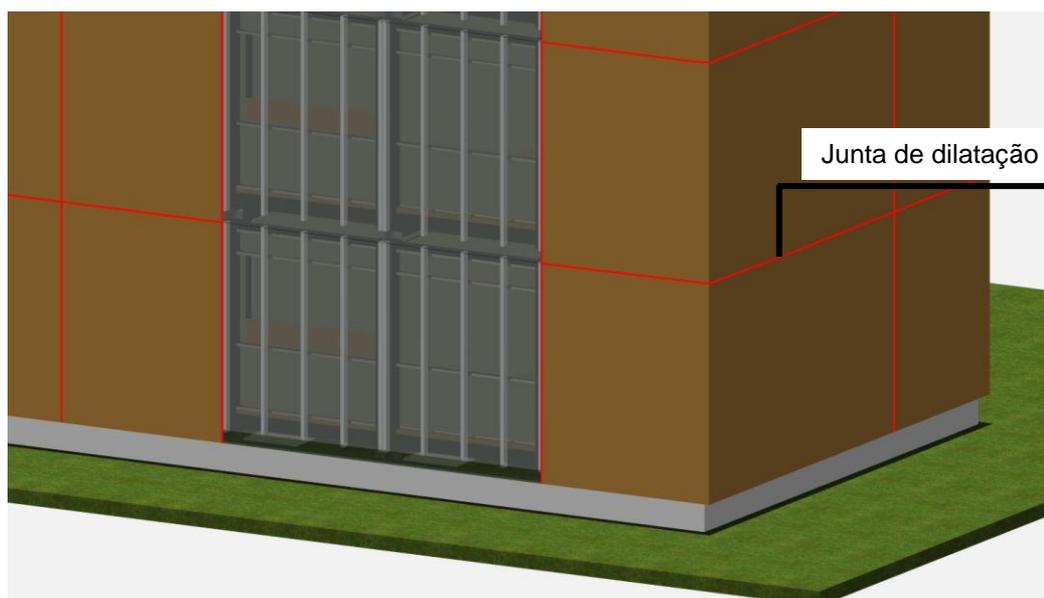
Vista do posicionamento das juntas horizontais e verticais de dilatação.
